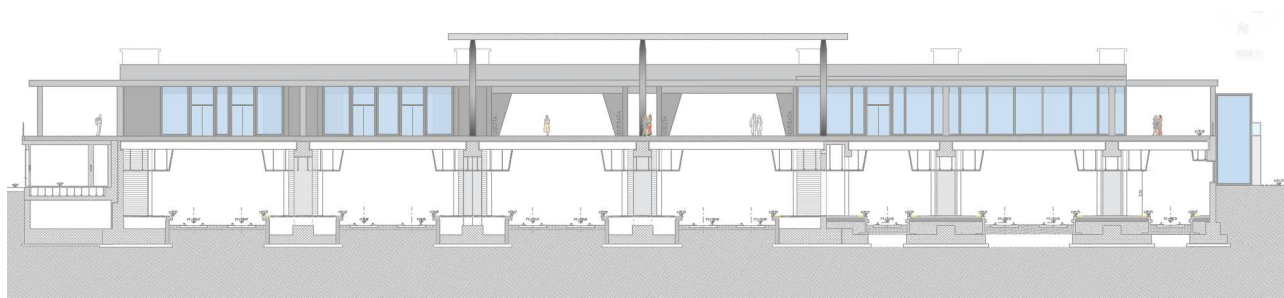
Sezione trasversale Piano Banchine nuovo (dx) ed esistente (Sx) in corrispondenza del piazzale.
